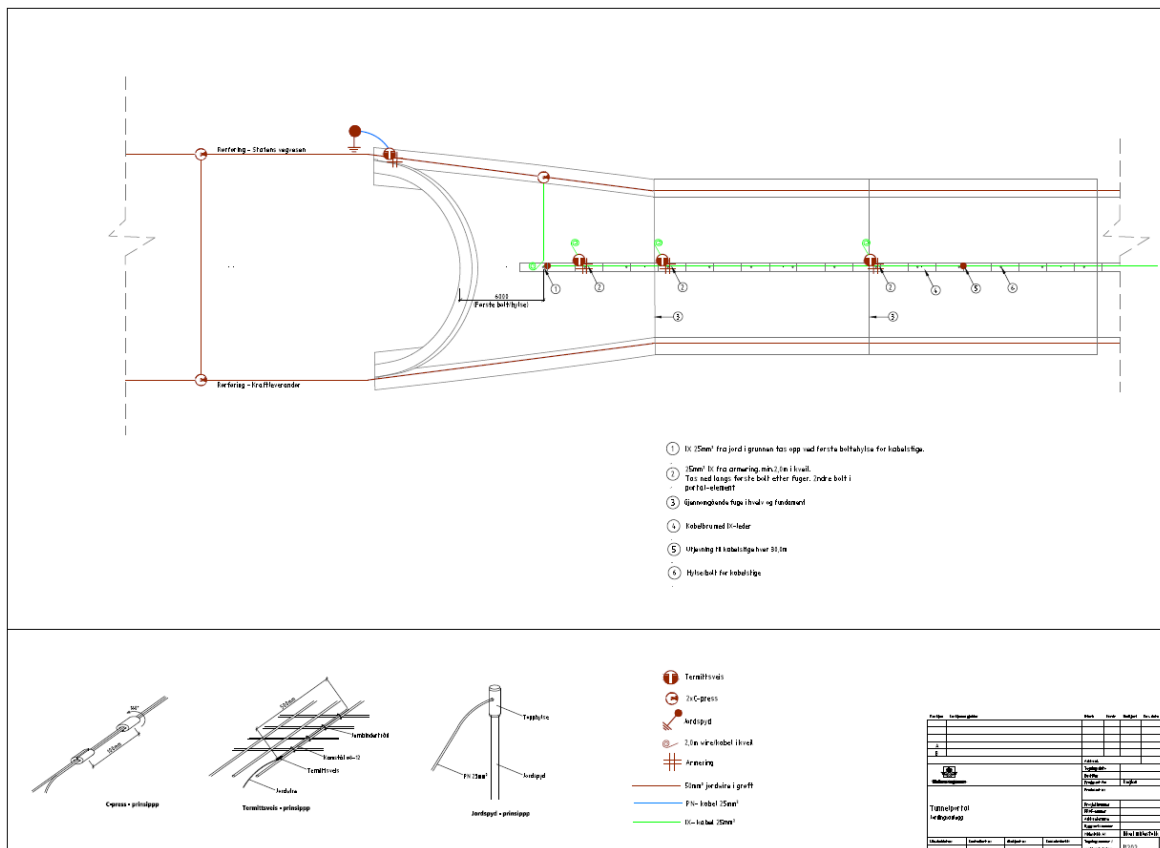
Eksempel på jording av tunnelportaler
